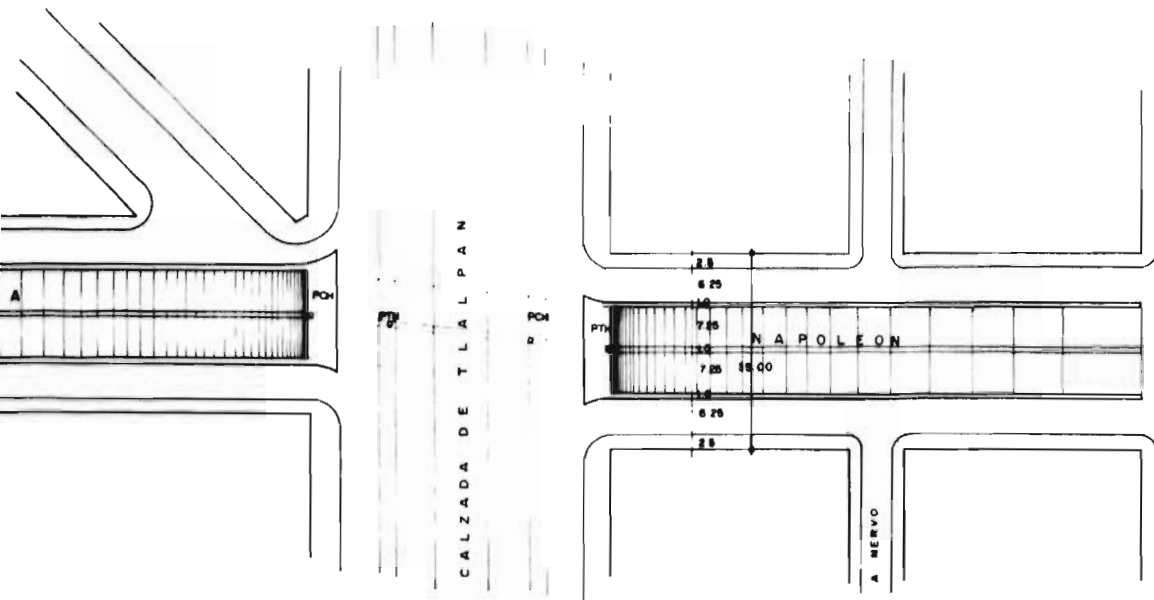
I. SECCION TRANSVERSAL DE LA ESTRUCTURA (PROYECTO) Y DE TLALPAN
